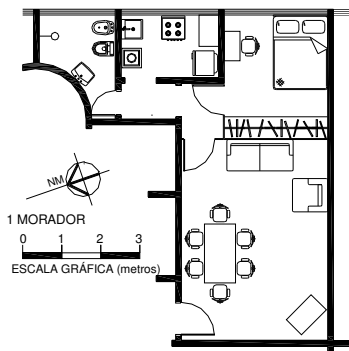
Layout de kitchenette Bloco E com separação da área de dormir.
